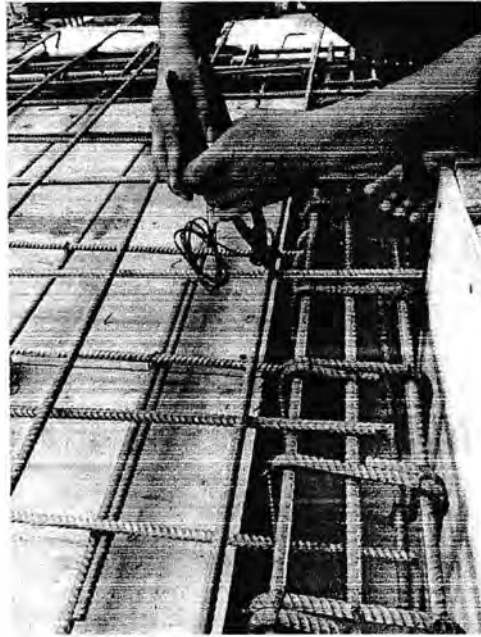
Pemasangan Bekisting Balok dan Plat Lantai
